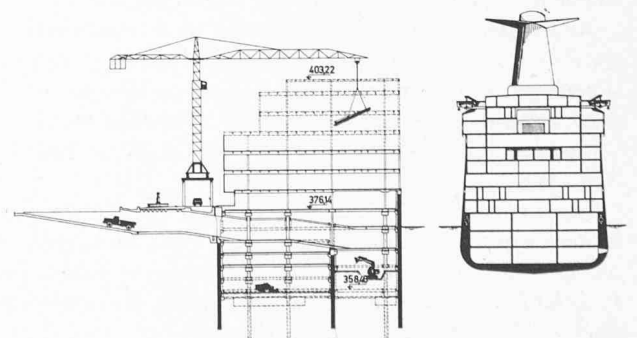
Coupe partielle de l'immeuble et celle du vaisseau « France ».
